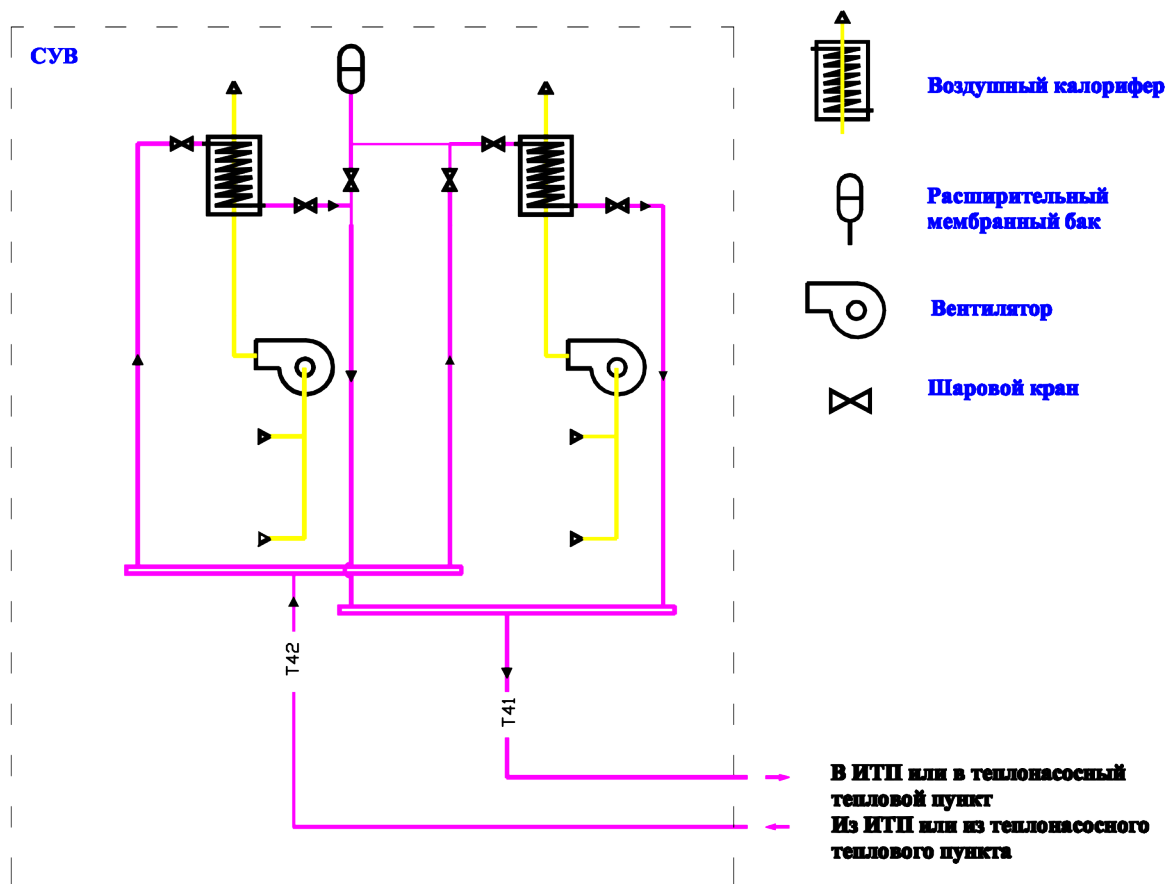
Схема вытяжной вентиляции с утилизацией тепла вытяжного воздуха многоэтажного жилого дома типовой серии
